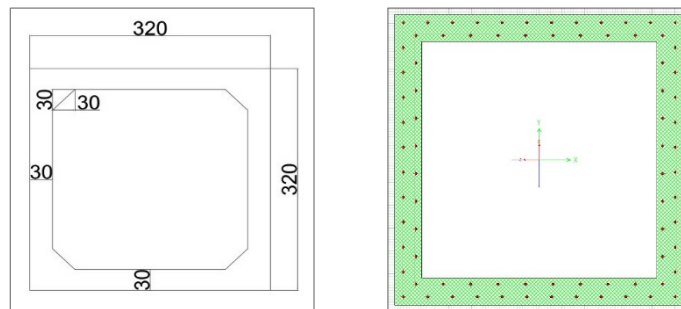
Dimensiones y distribución de refuerzo de la sección de los travesaños de la torre en el tramo atirantado.
